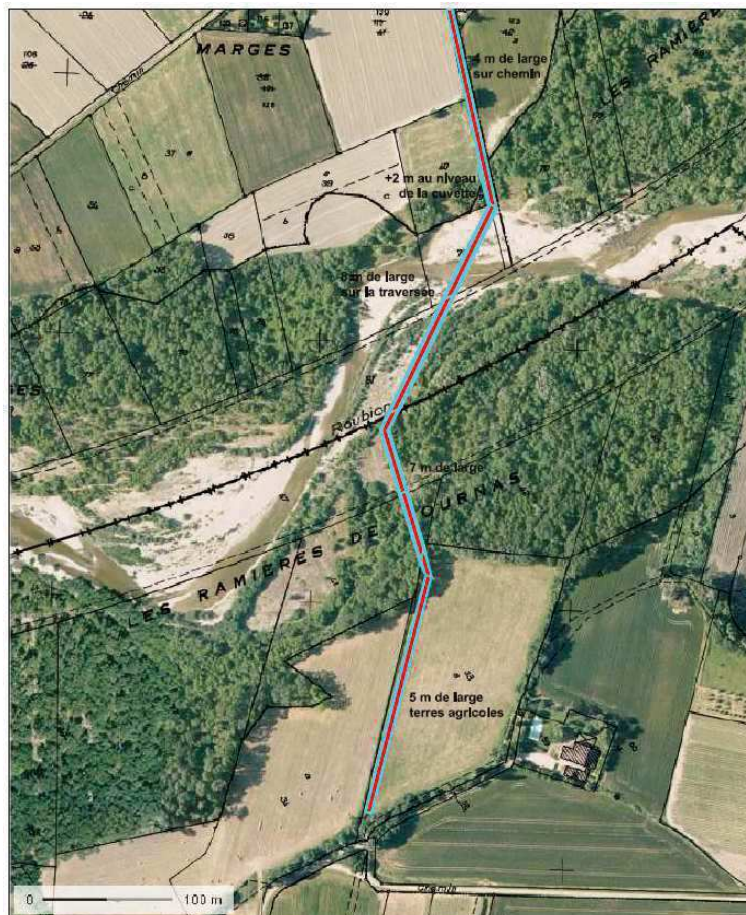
Schématisation du tracé projeté de la conduite et de l'emprise des travaux sur vue aérienne
